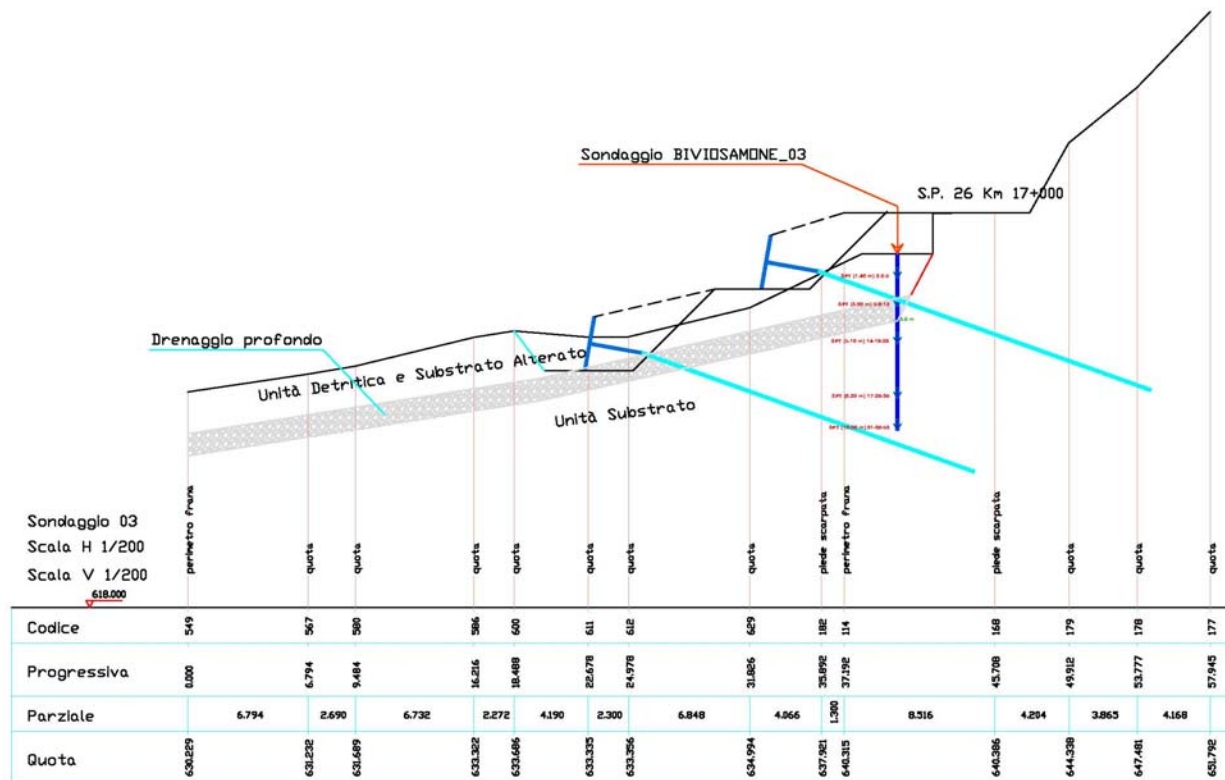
Sezione litotecnica di progetto coincidente con la sezione topografica n. 3
